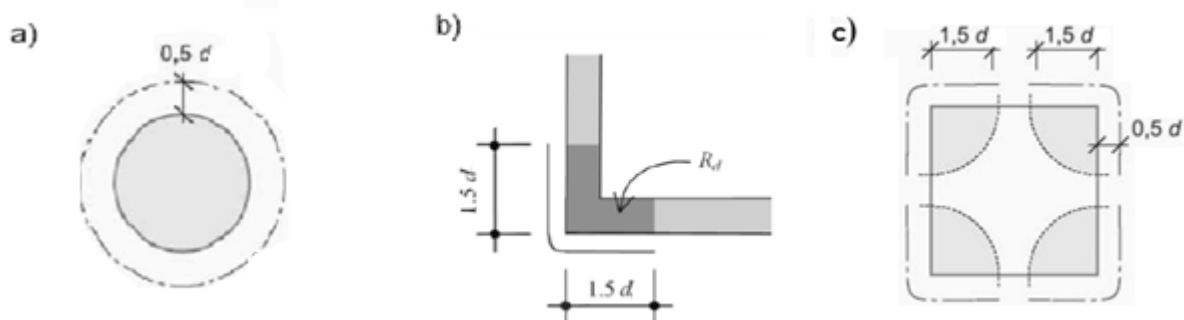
Exemplos de perímetros de controlo em: a) pilar; b) parede; c) limites
